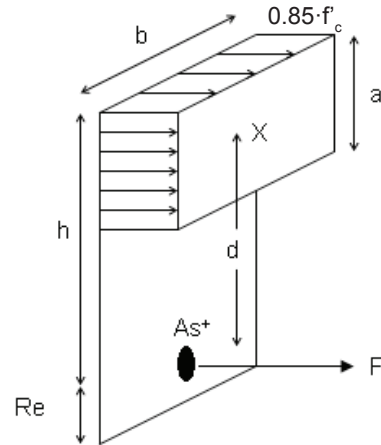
"Esfuerzos aplicados sobre la sección de losa". Fuente: Elaboración propia.
